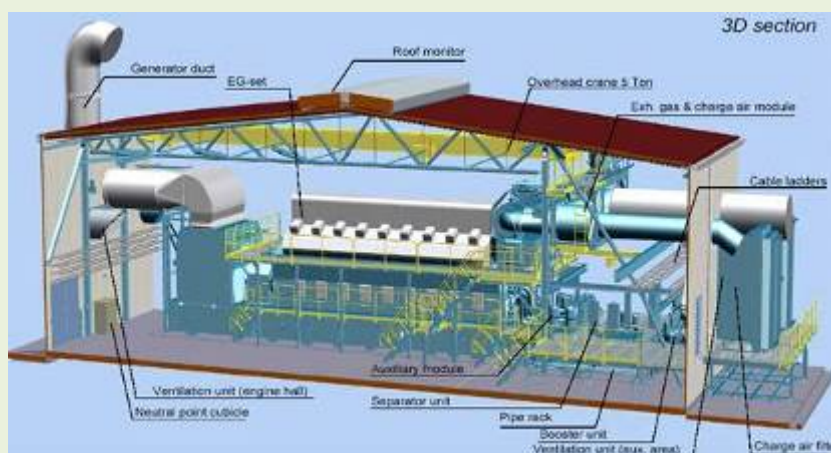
Instalação do Grupo Motor Diesel-Gerador.
